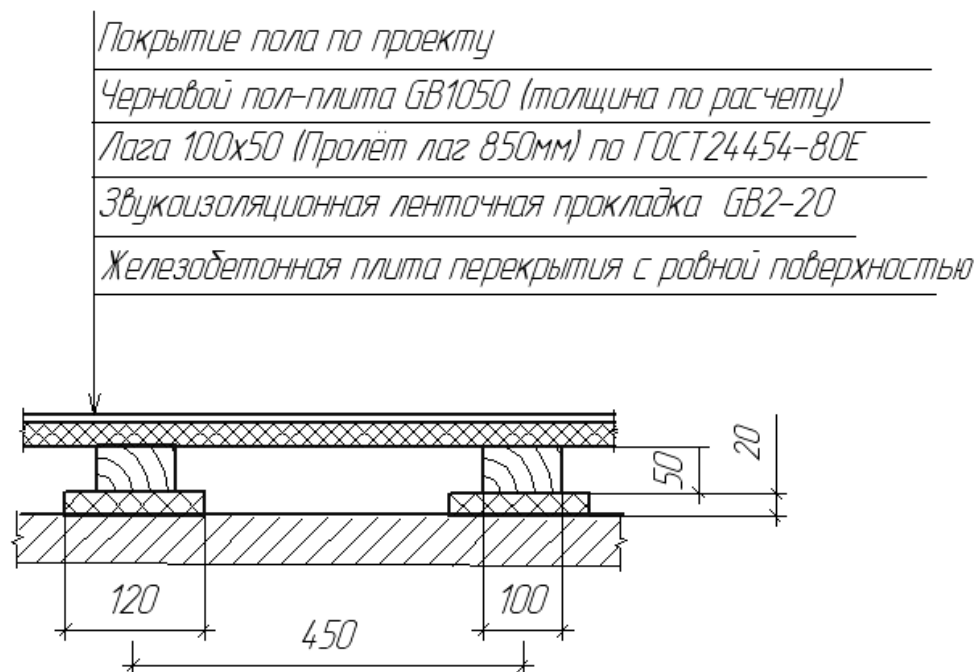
Конструкция пола по железобетонной плите перекрытия без утепления с применением системы плит GREEN BOARD®
